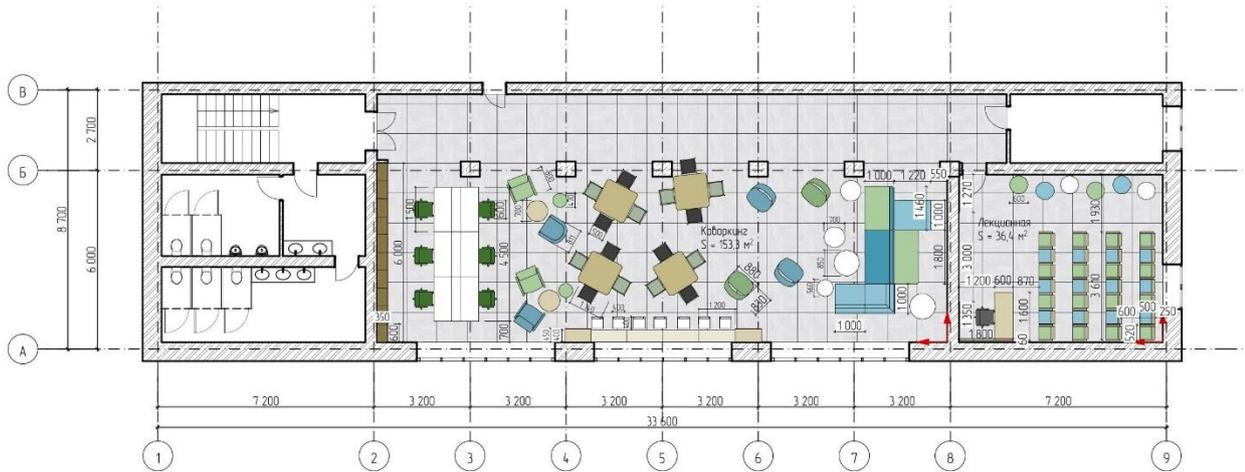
План пола с расстановкой оборудования (второй этаж)
